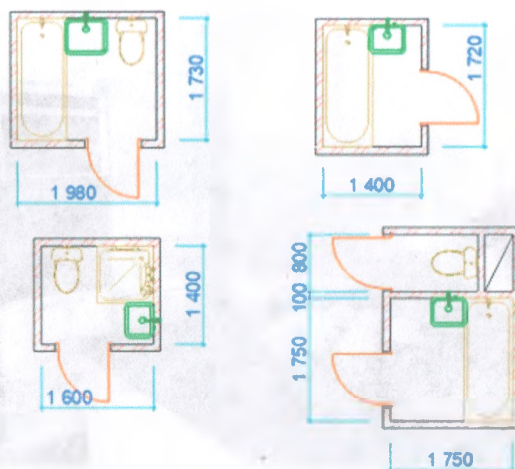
Типы планировочных решений санитарных узлов и ванных комнат
